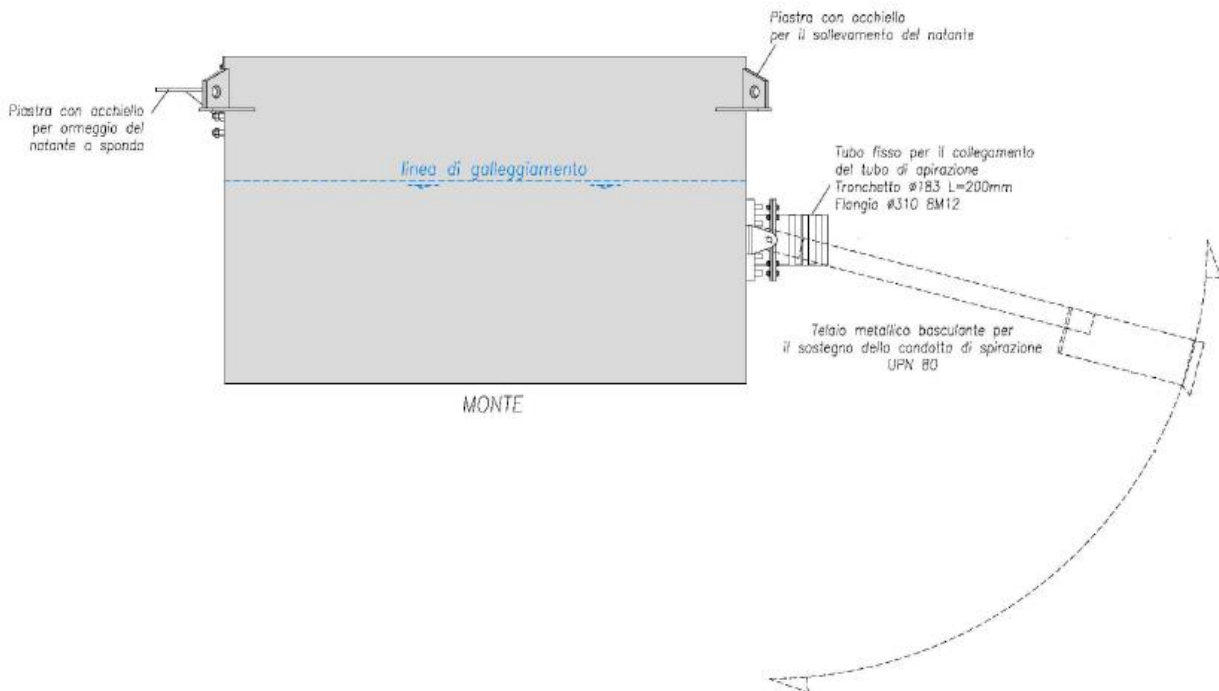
Prospetto laterale stazione pompaggio galleggiante - monte
